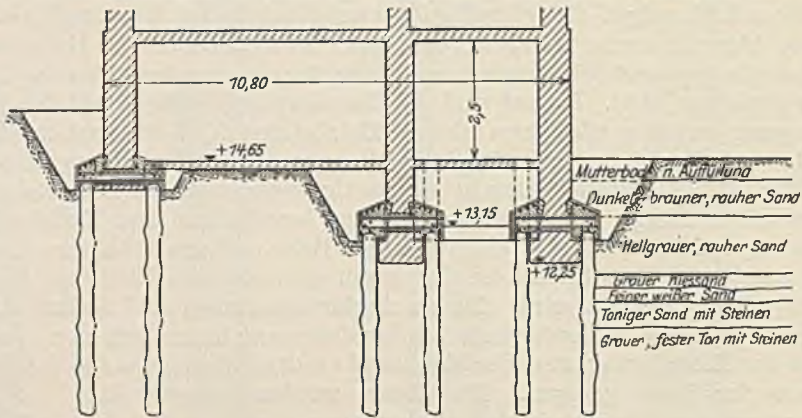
Bauwerkunterfangung durch Straußpfähle.
